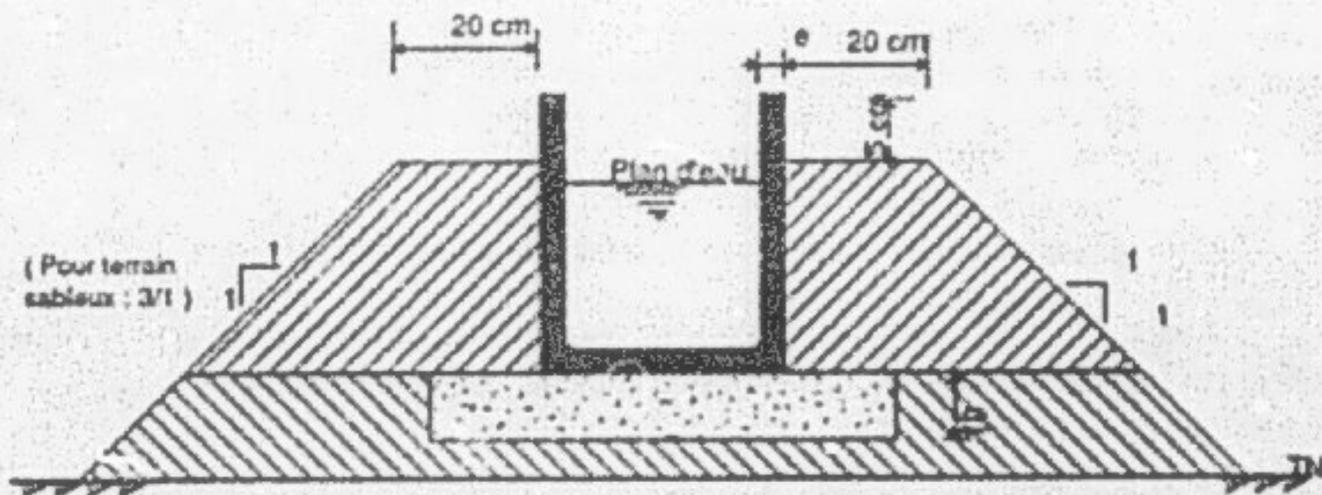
Section transversale type d'un canal rectangulaire en remblais
